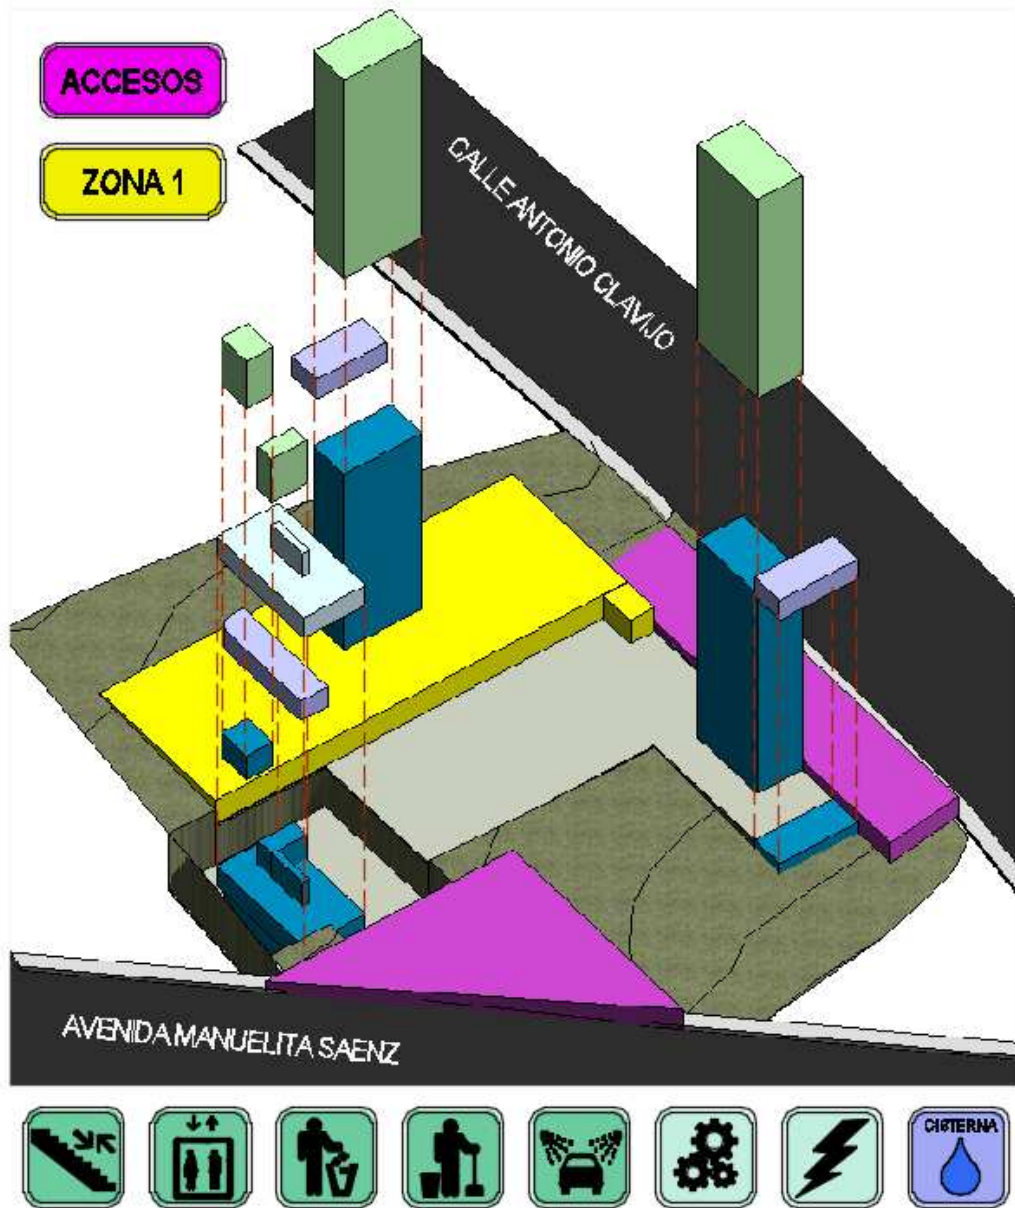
Plan Masa. Zona 1. Parqueaderos y control. Accesos
